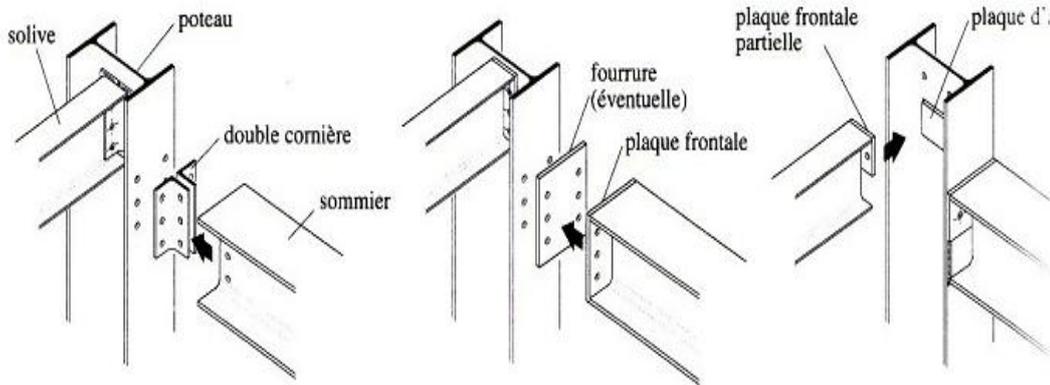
assemblage poteau- poutre. (Source : La conception de la charpente métallique)
